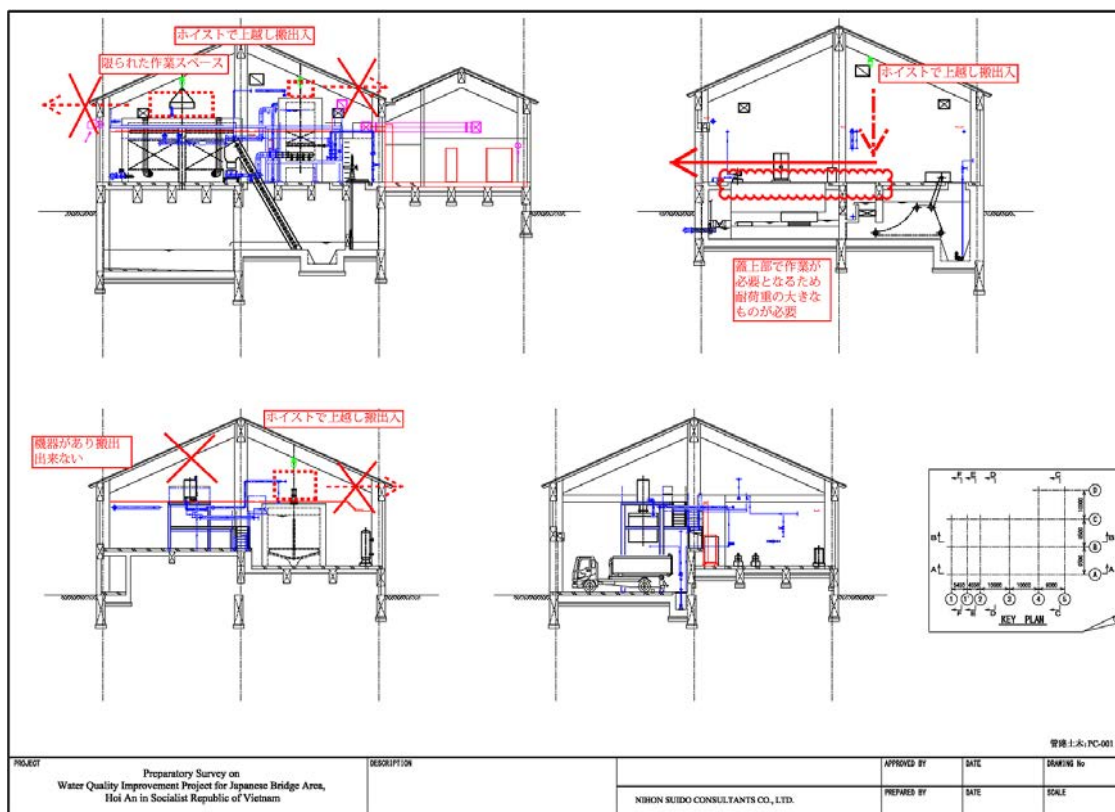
コンクリート製タンクの機器搬出入ルート（断面図 2）
